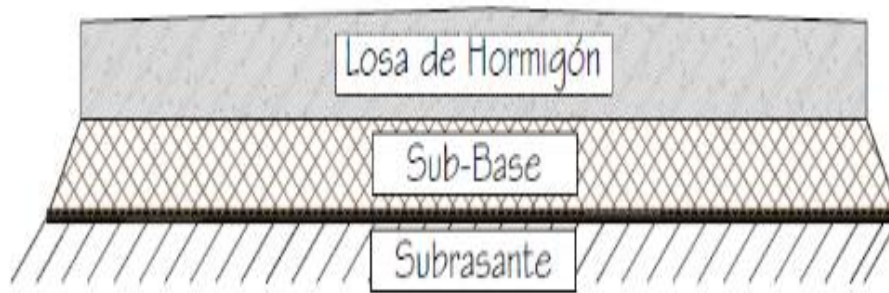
Tipos de pavimentos flexibles y rígidos, sección típica transversal pavimento rígido (Armijos -2009)
